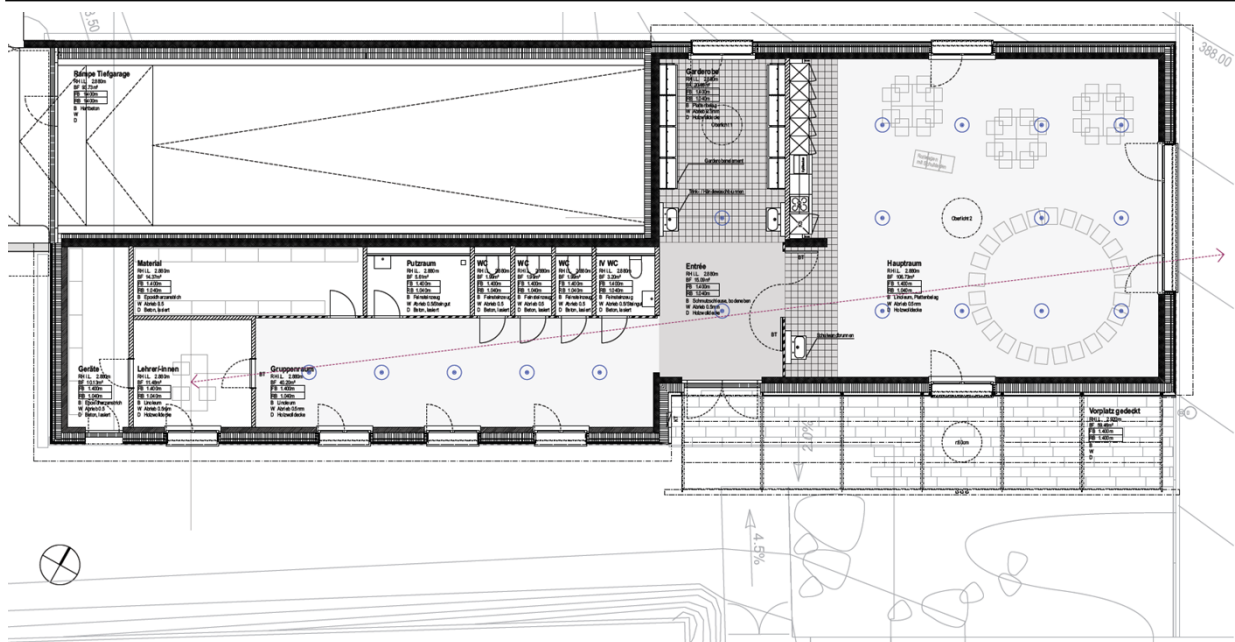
Grundriss Erdgeschoss (Quelle: Galli Rudolf Architekten AG)
